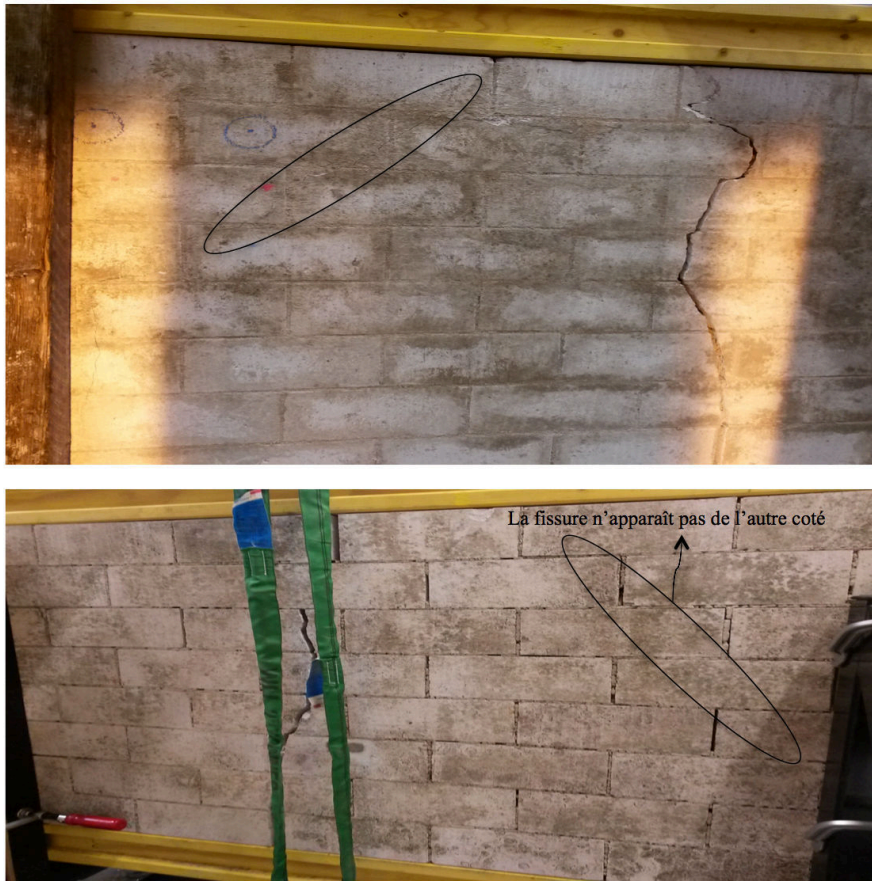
Fissuration du mur F2: une fissure apparaît d'une seule part sans être visible de l'autre part du mur
